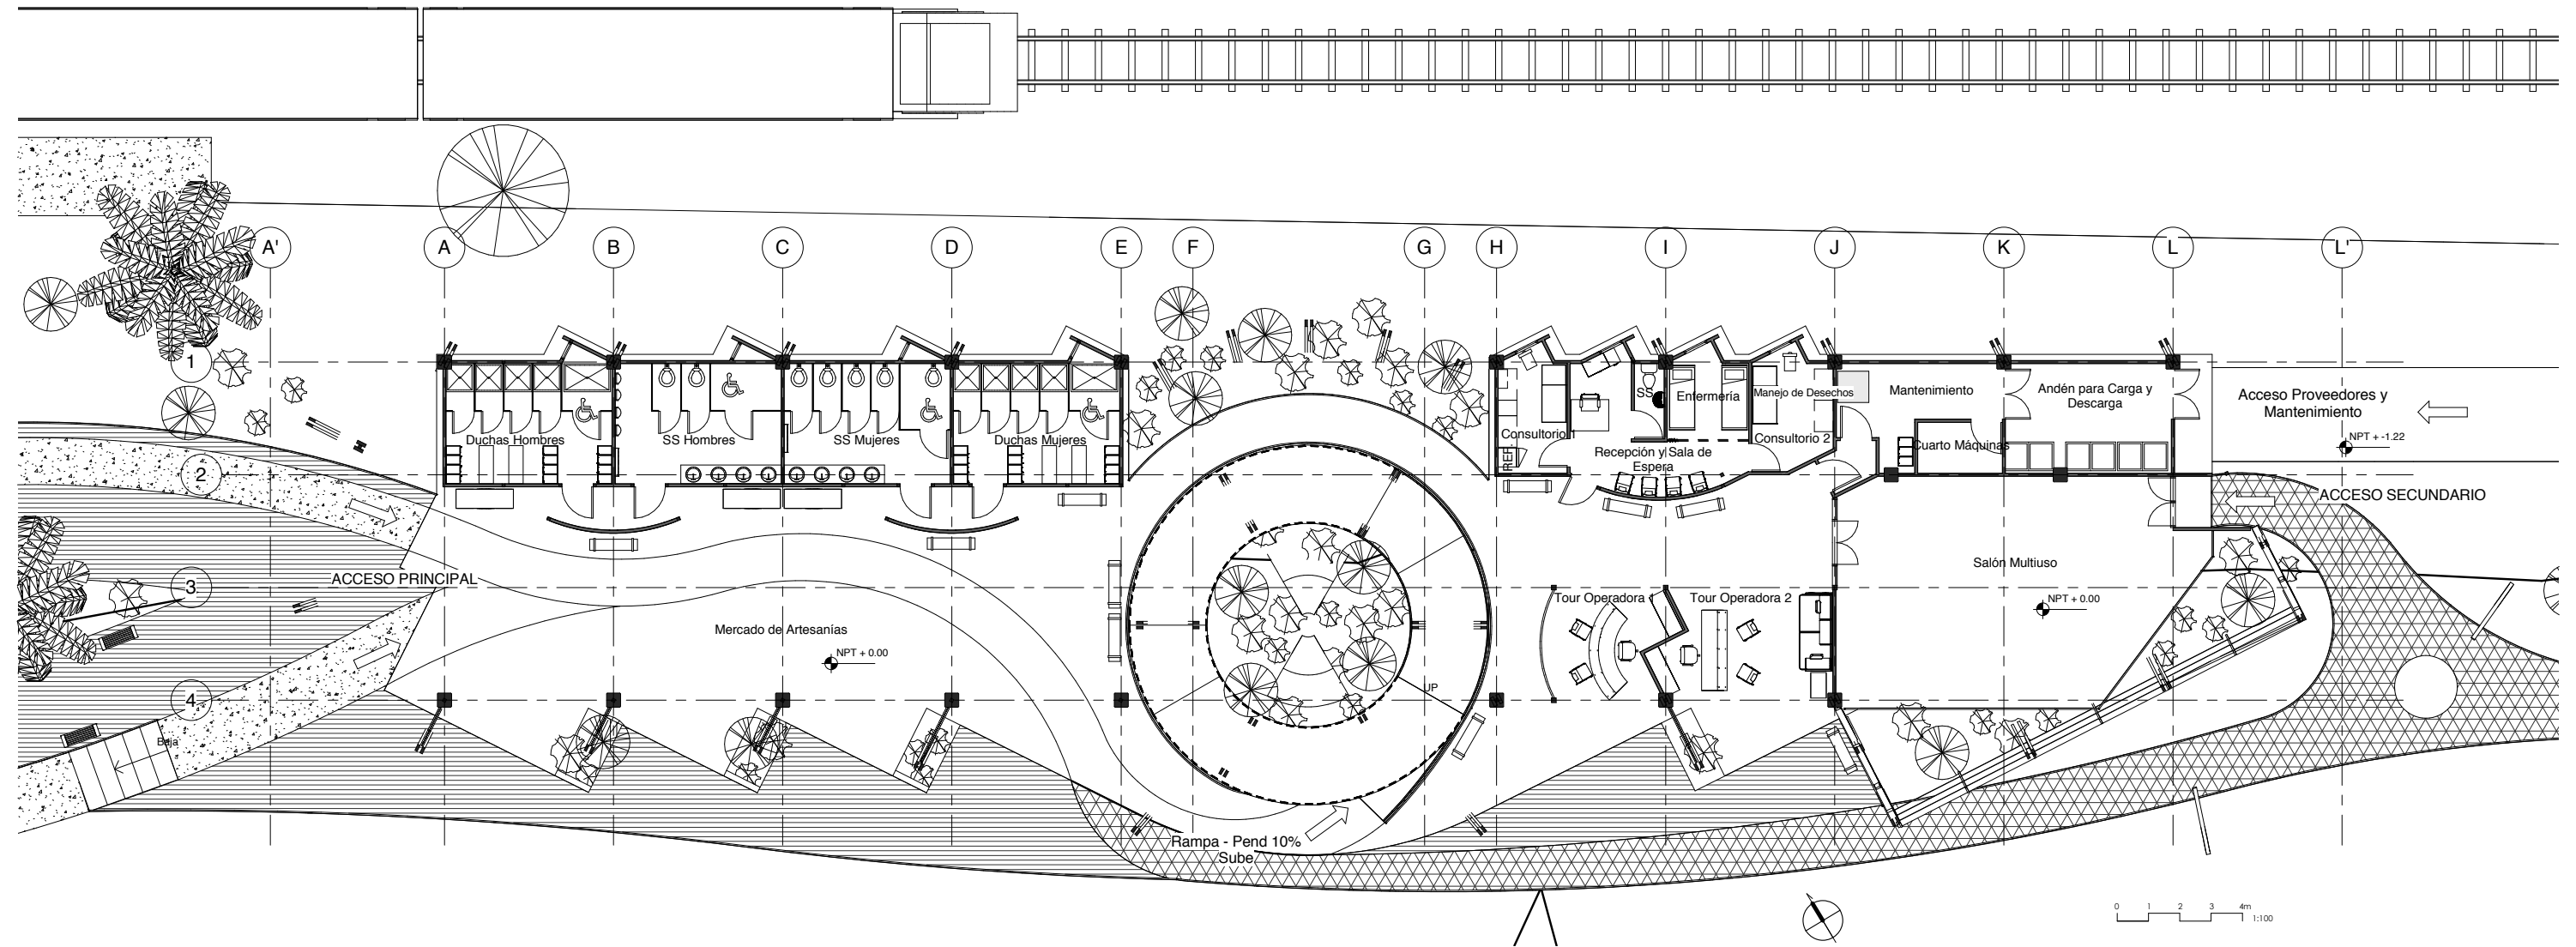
Planta de Distribución Arquitectónica - Primer Nivel Núcleo de Facilidades Turísticas.
